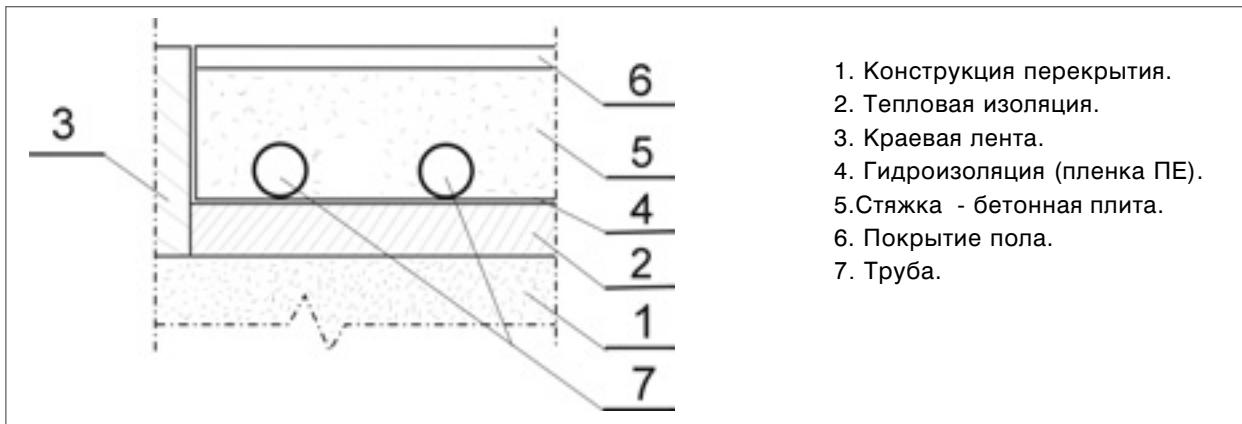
Схема конструкции подпольного нагревателя с укладкой мокрым методом.
